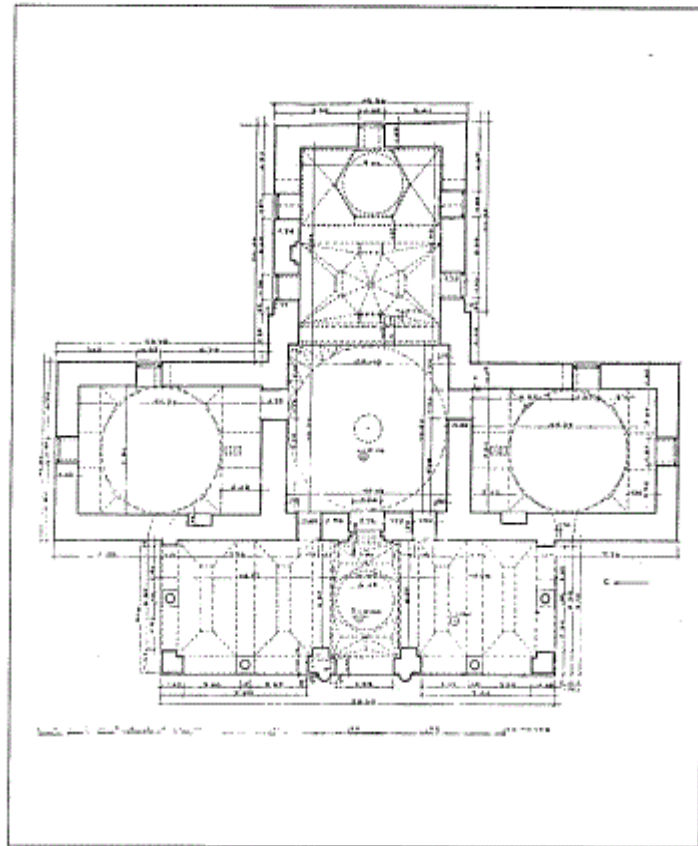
مسقط أفقي لعمارت غازي اورنوس بك في كوموتيني باليونان
